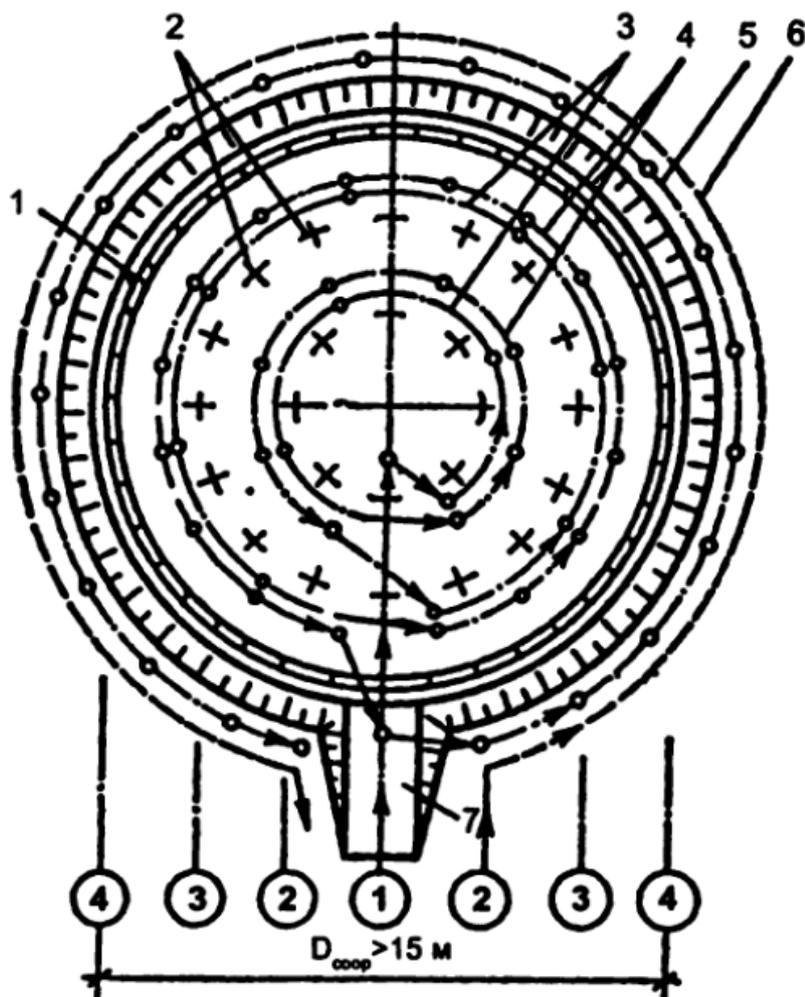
Принципиальная схема монтажа крупного цилиндрического резервуара: 1 – стеновые панели; 2 – места установки колонн; 3 – ось движения крана при монтаже колонн; 4 – то же, при укладке ригелей и плит покрытия; 5 – то же, стеновых панелей и плит покрытия последнего ряда; 6 – ось движения транспортных средств; 7 – въезд и выезд из котлована
